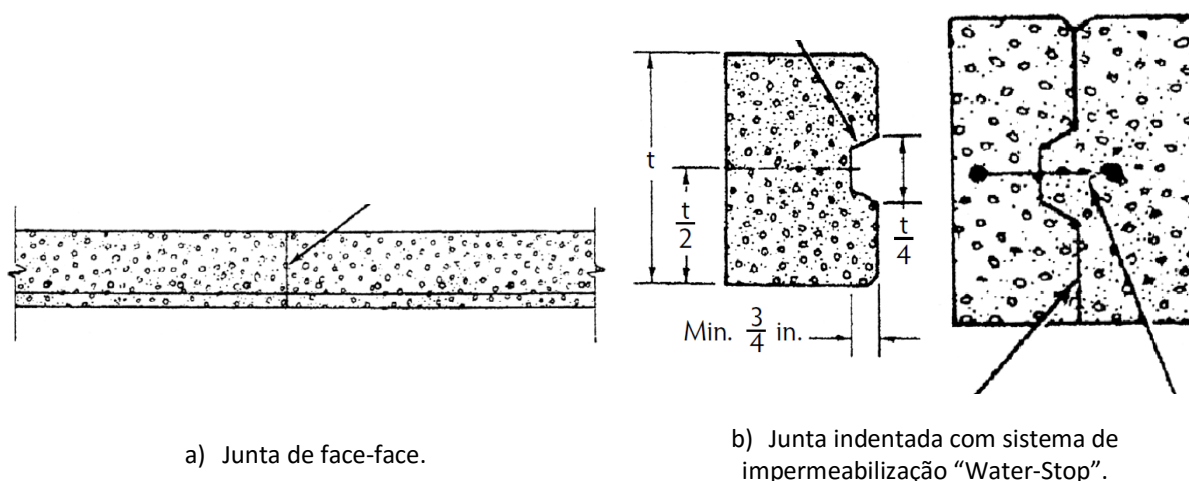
Dois tipos de juntas de construção ou betonagem. (Edward G. Nawy, D.Eng., P.E., 2008)
